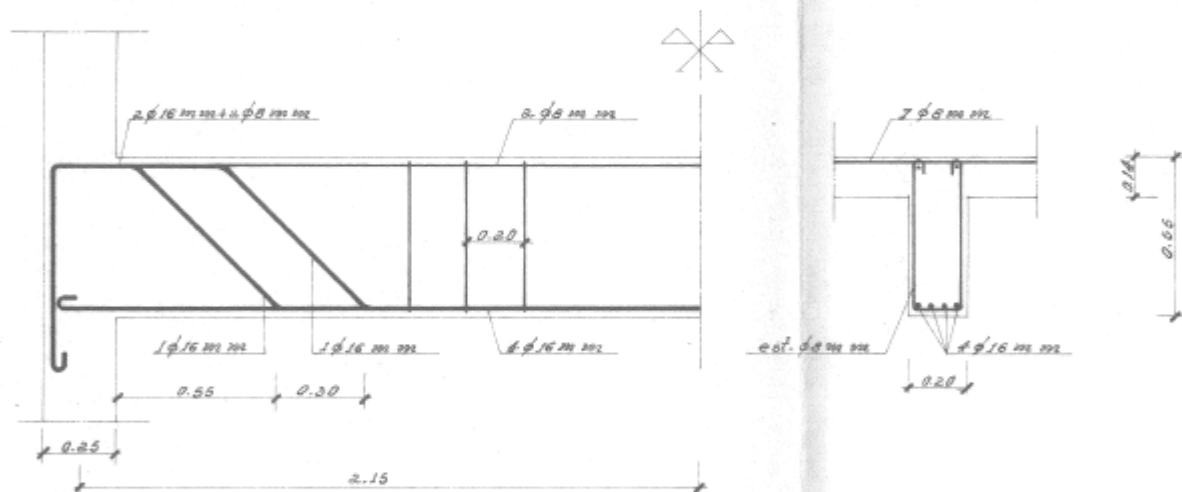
Pormenorização das armaduras: Vigas V4, V5, V6.(Projetos Originais)
